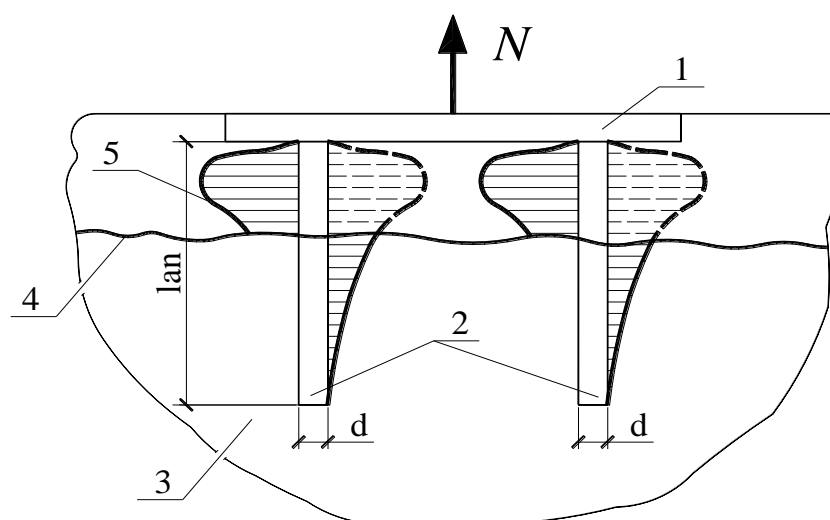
К расчету закладных деталей на выдергивание: 1 – металлическая пластина закладной детали; 2 – арматурные стержни закладной детали; 3 – бетонная матрица; 4 – трещина в бетонной матрице; 5 – эпюра касательных напряжений
